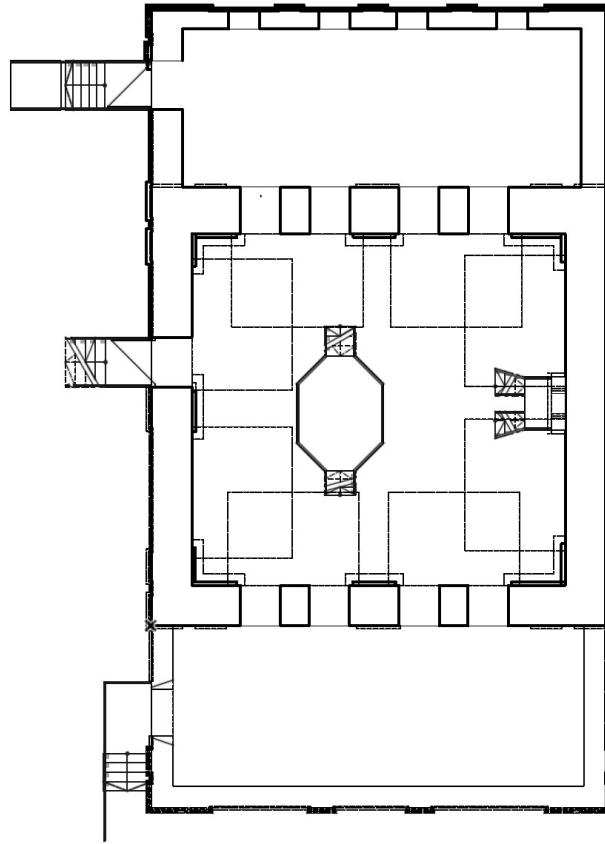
Zamosc_Grundriss_Erdgeschoss.png
